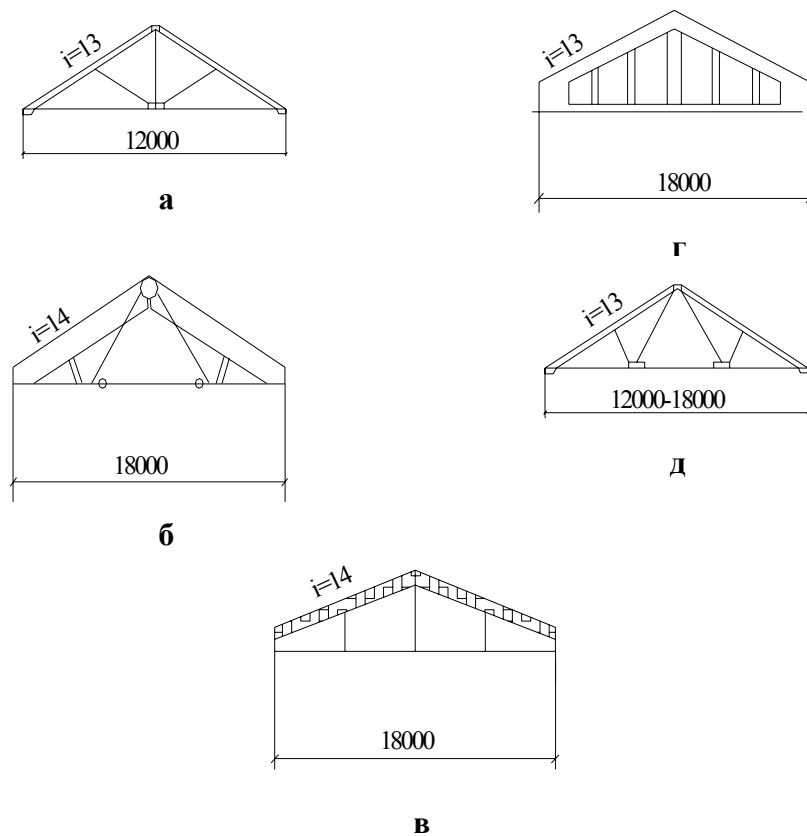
Несучі конструкції ферм покриття будинків:
